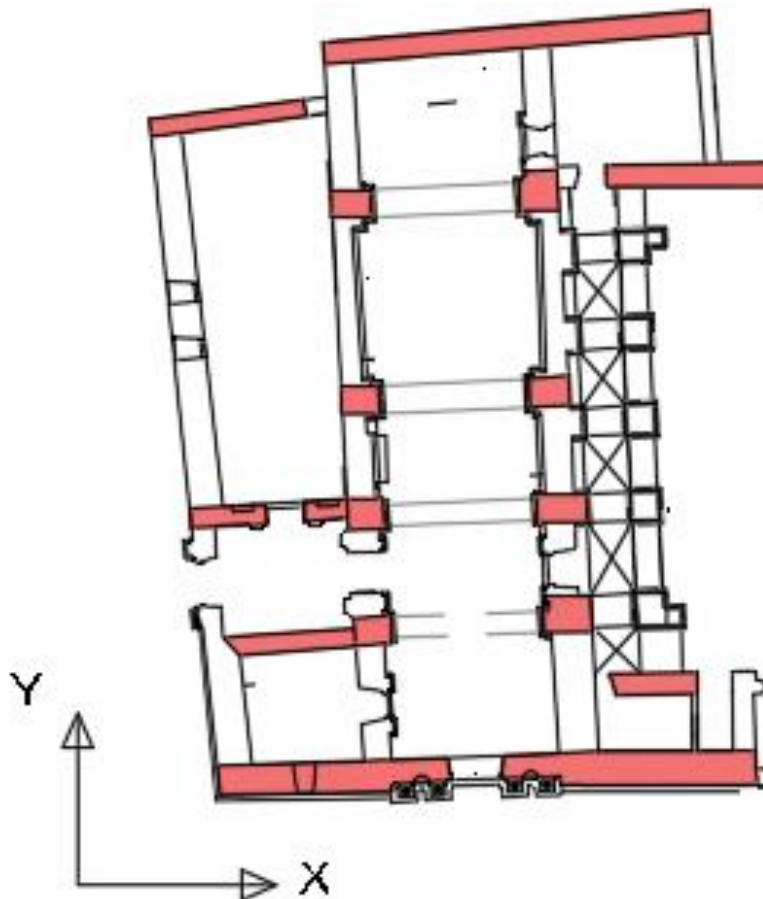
Área en planta de los muros resistentes en el eje X.
